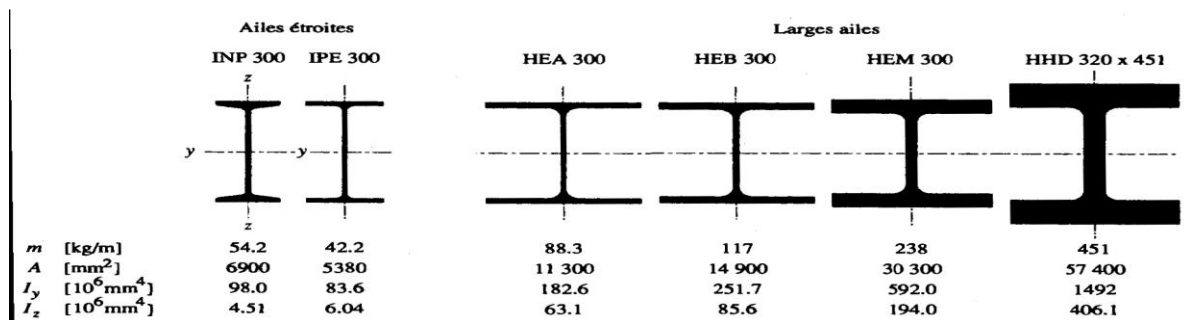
Exemple des profilés en I et des poutrelles HE [4]
